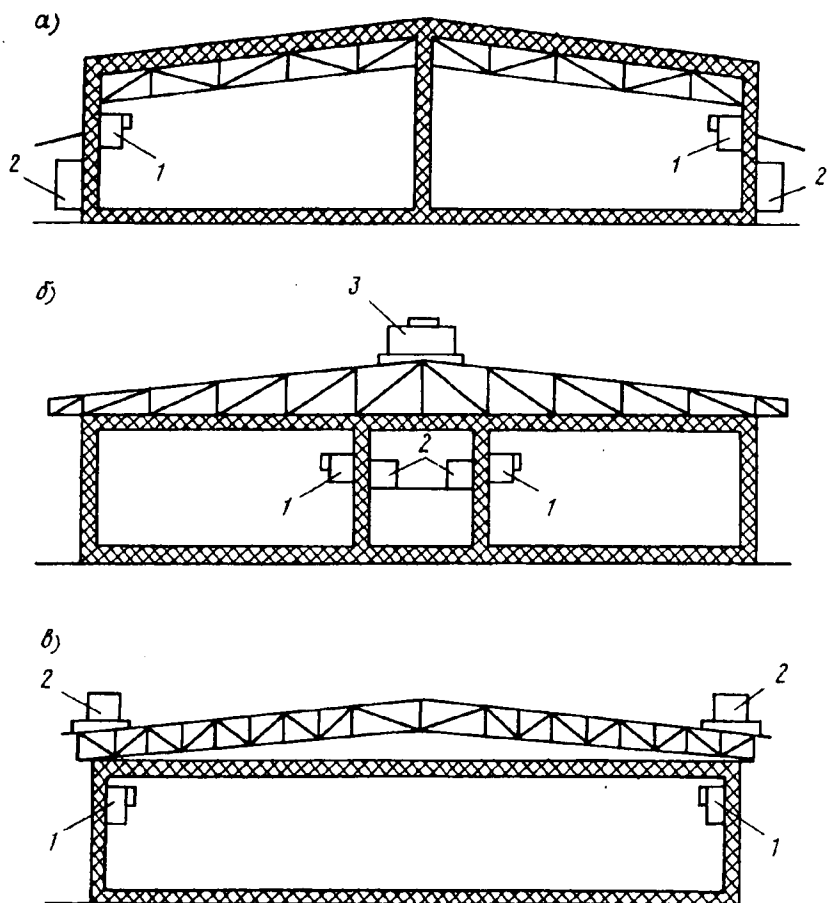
Размещение блочных холодильных машин в камерах одноэтажного холодильника: а — под навесом; б — на техническом этаже; в — на кровле;
